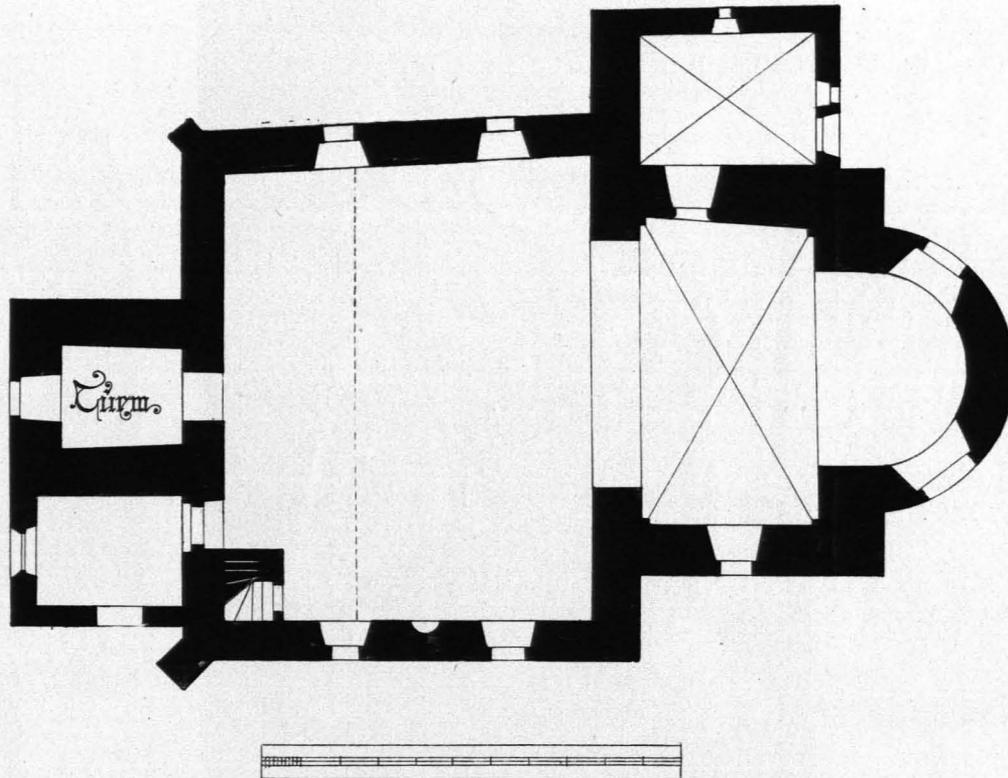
Waldhausen, Pfarrkirche, Grundriß 1 : 200 (S. 415)
